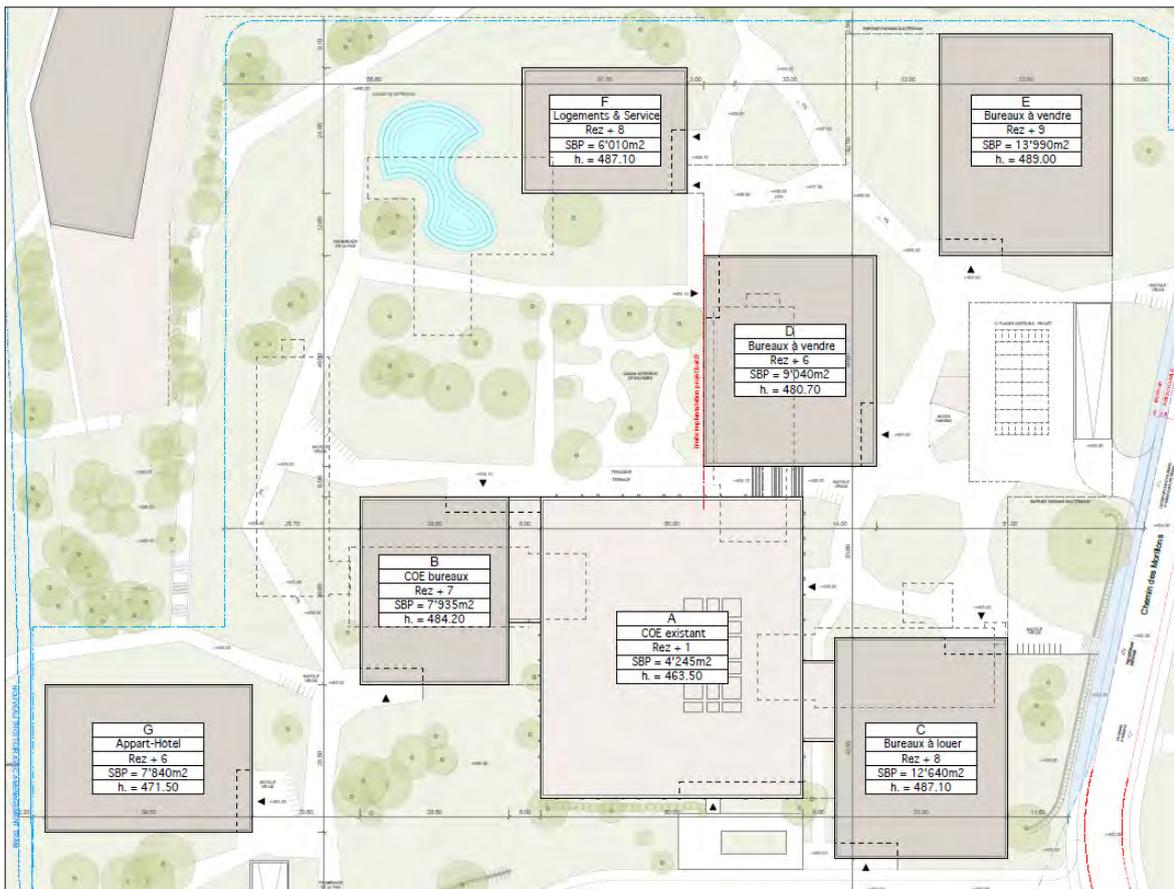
Plan masse des bâtiments A à G projetés (source : LRS architectes)
